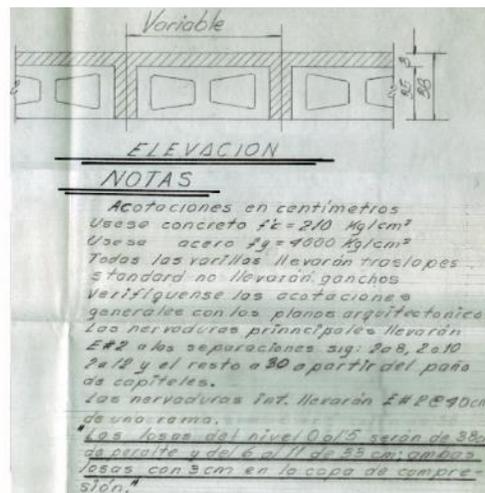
Plano estructural de distribución de bloques -detalle de “elevación losa encasetonada” del edificio ubicado en Lope de Vega núm.304. Este detalle diseñado en la oficina del ingeniero Humberto Panuco fue el más repetido en las soluciones estructurales de entrepisos.
